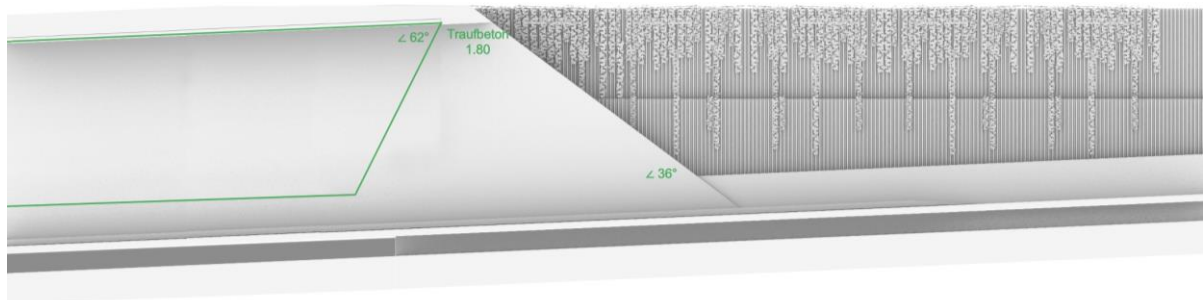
Abwicklung mit Übergang Tunnelwand (Lärmschutzelemente) / Portalbereich (Sichtbeton) / Stützmauer (Lavabeton, Begrünung).
